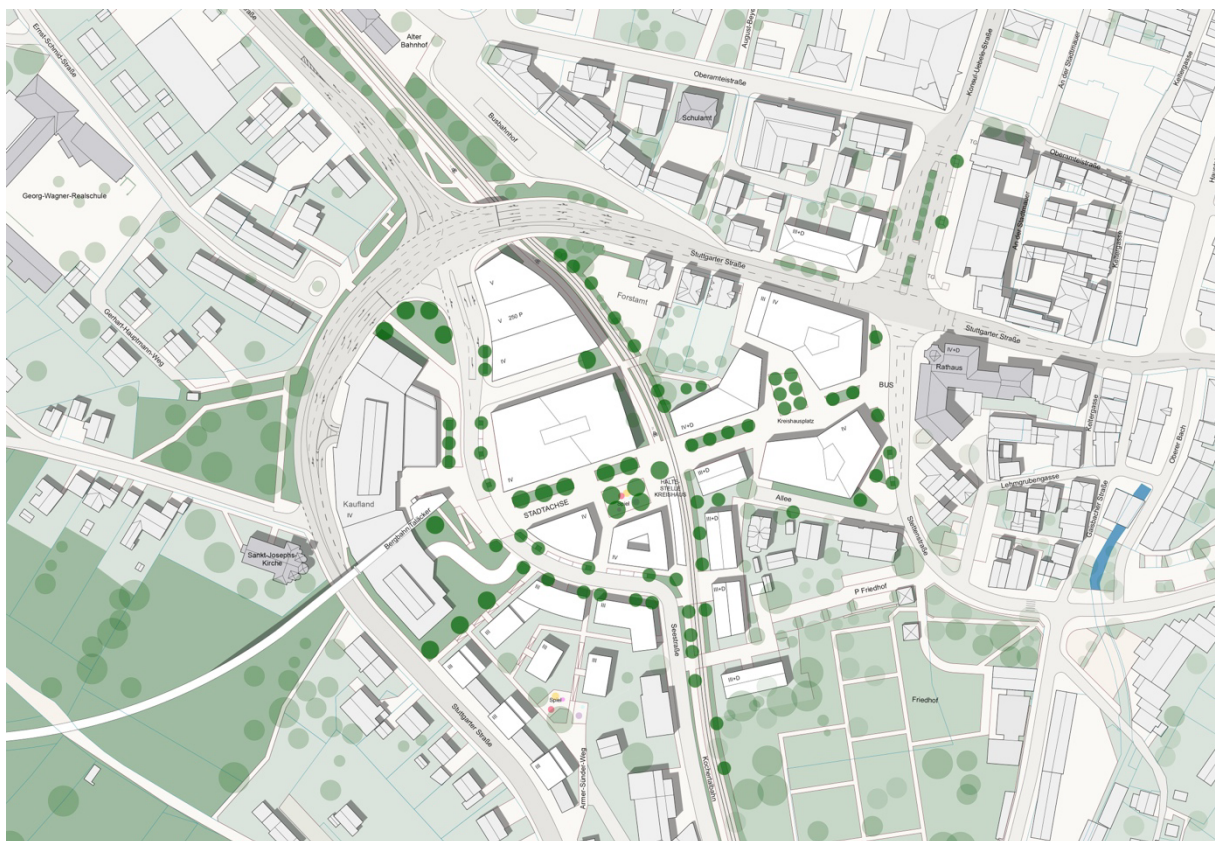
Fortschreibung Rahmenplan Stadteingang Stuttgarter Straße, Oktober 2022
